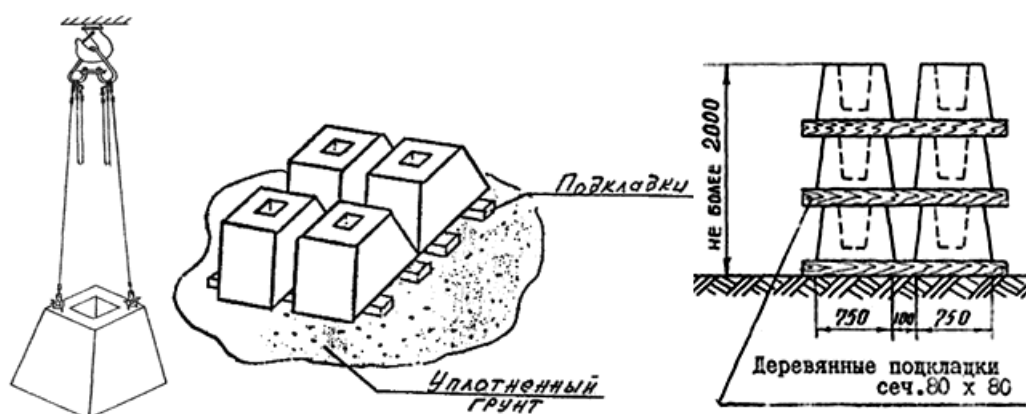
Схема строповки и складирования фундаментных блоков на объекте
